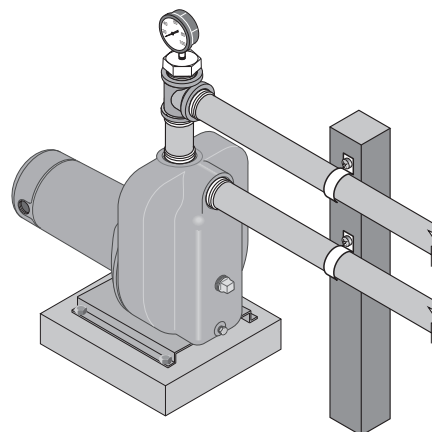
SOUTIEN DE CHAQUE TUYAU FIXÉ À LA POMPE
